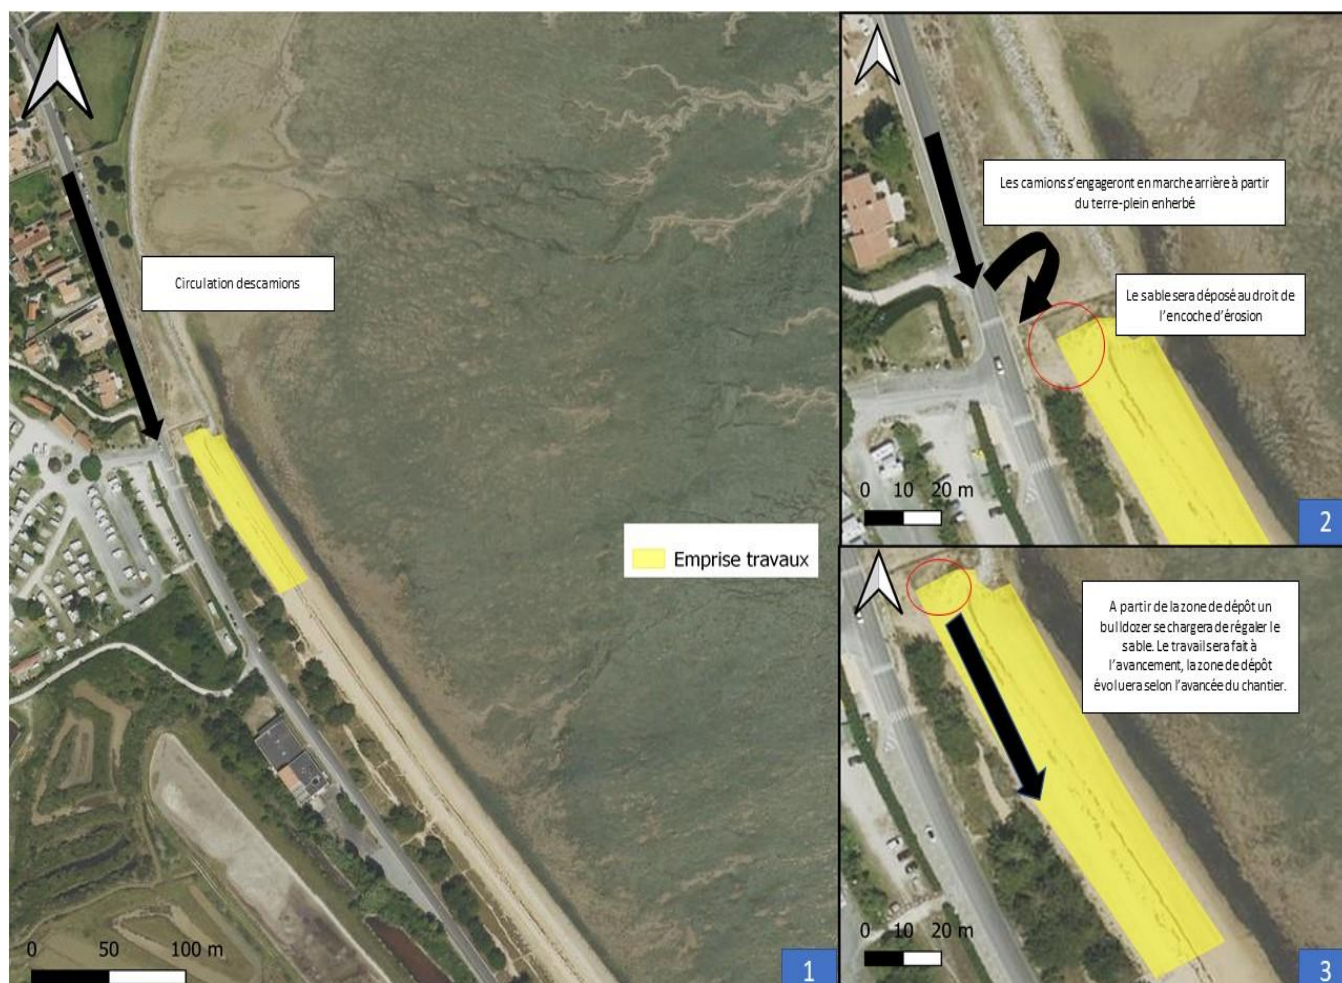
PLAN DE SITUATION DU CHANTIER DE RECHARGEMENT
